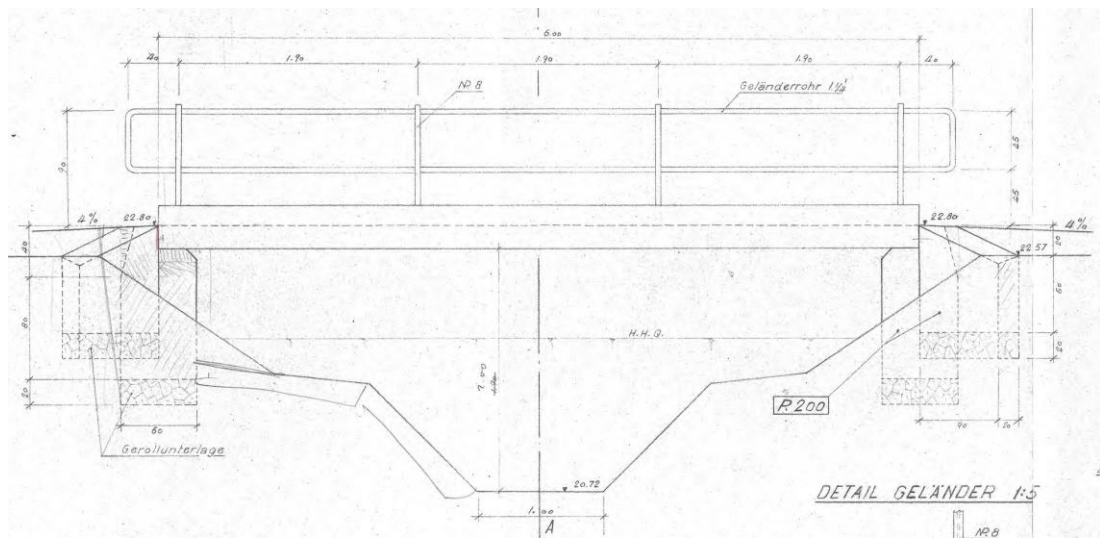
Auszug Ausführungsplan best. Brücke, Aufriss
